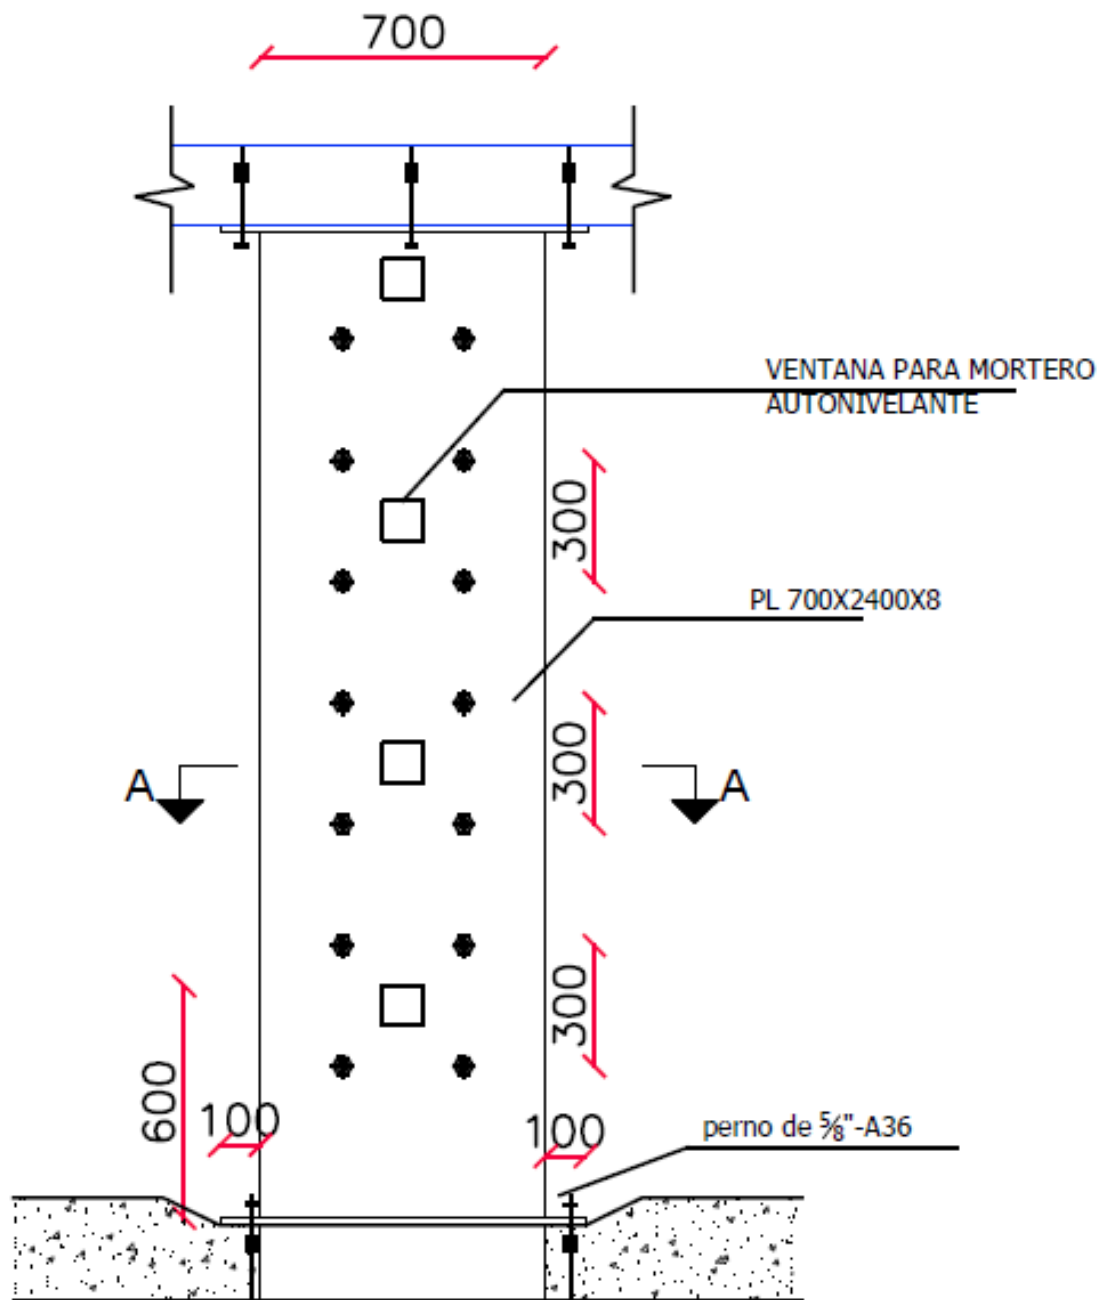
Detalle de la ubicación y corte de las platinas en las caras No 1 y 3.
